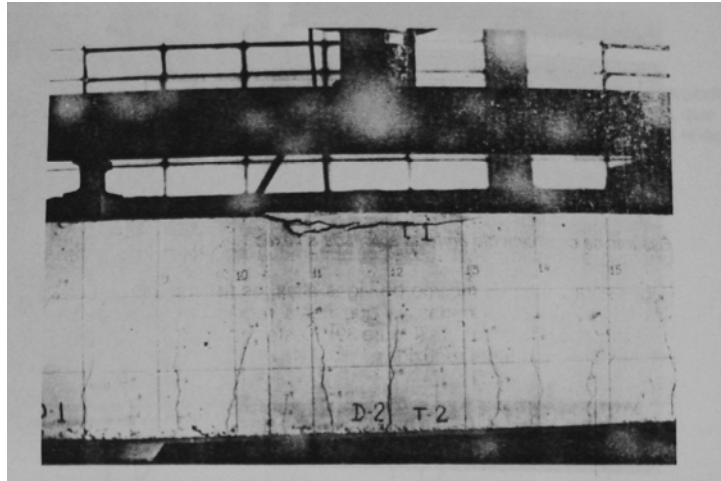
Fissuras de flexão em viga de concreto armado descimbrada e carregada precocemente. (Fonte: THOMAZ)
